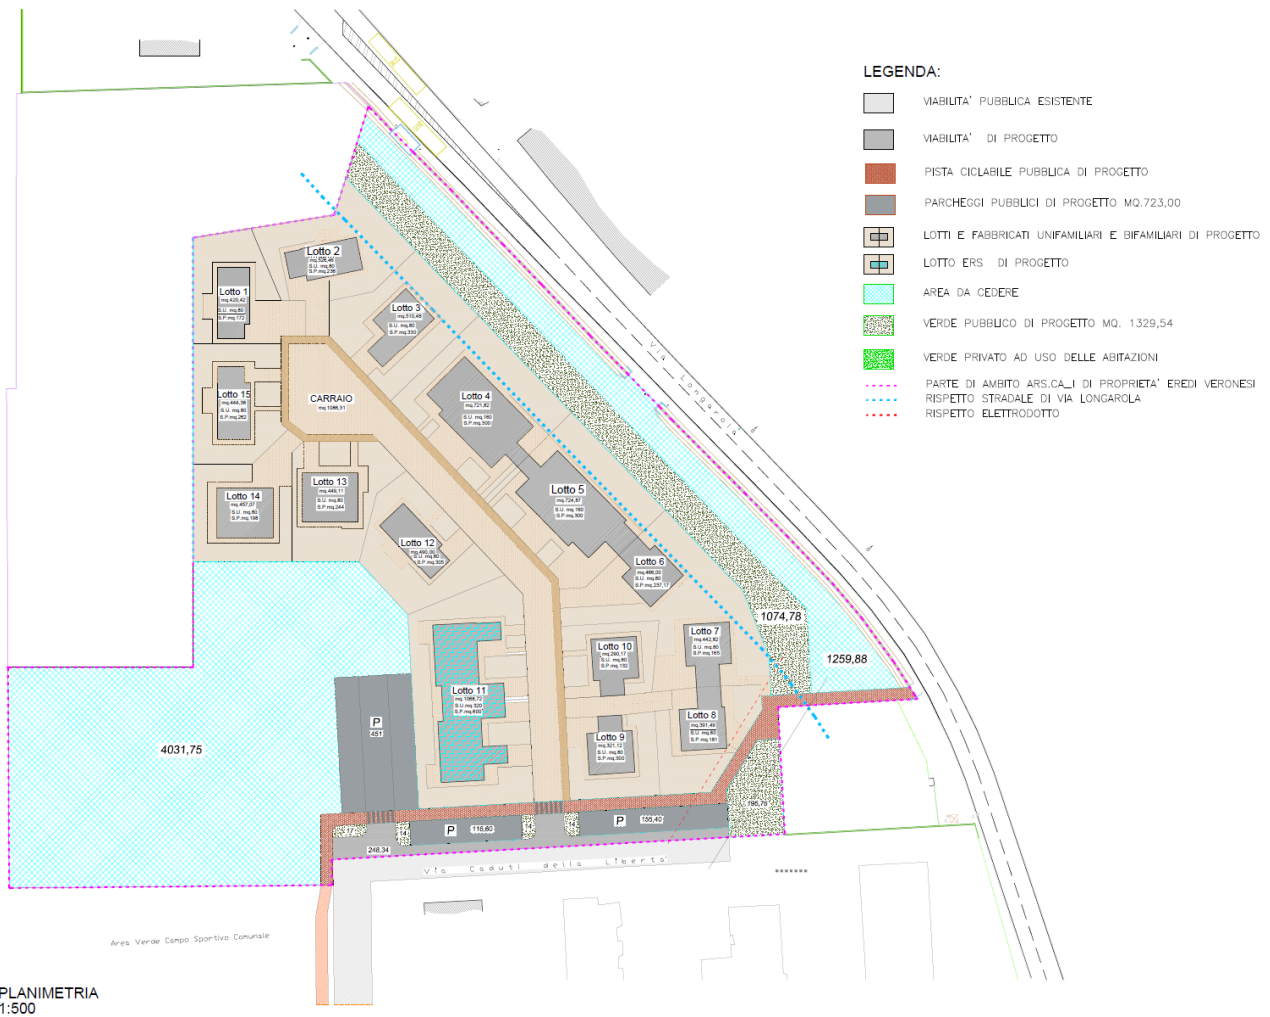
Assetto Urbanistico di previsione – Stralcio planimetrico
